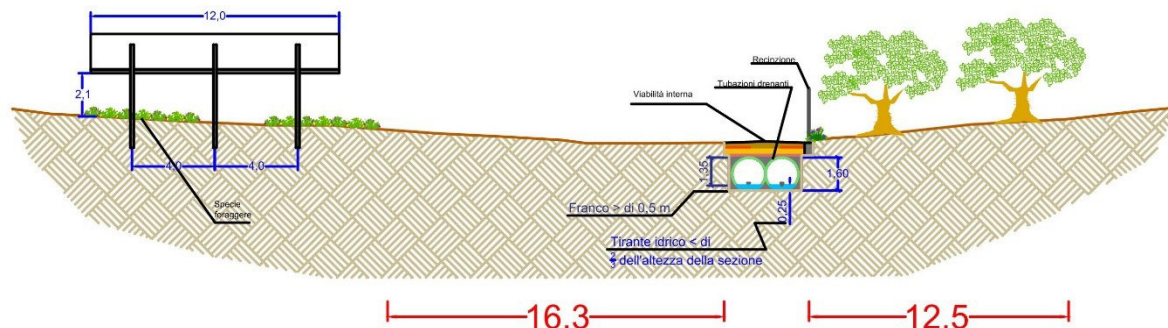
Attraversamento corso d'acqua localizzato all'interno dell' "Area C" con la viabilità interna di nuova realizzazione e indicazione posizione tubazioni drenanti a sezione circolare di nuova realizzazione – estratto dell'elaborato di progetto "Tav.34 Inquadramento su CTR ante e post operam su bacini idrografici"
